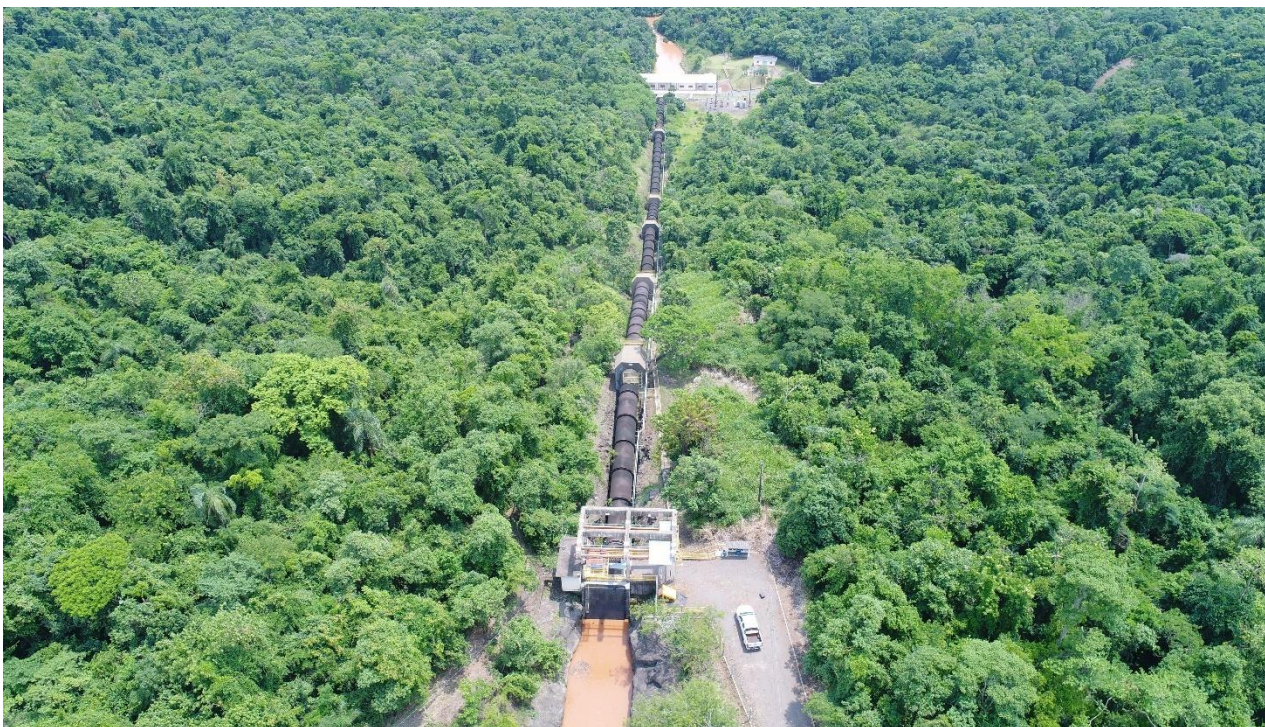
Vista geral do conduto forçado da PCH Salto Natal – Coordenada da foto: -24.062038°/-52.291378°.
